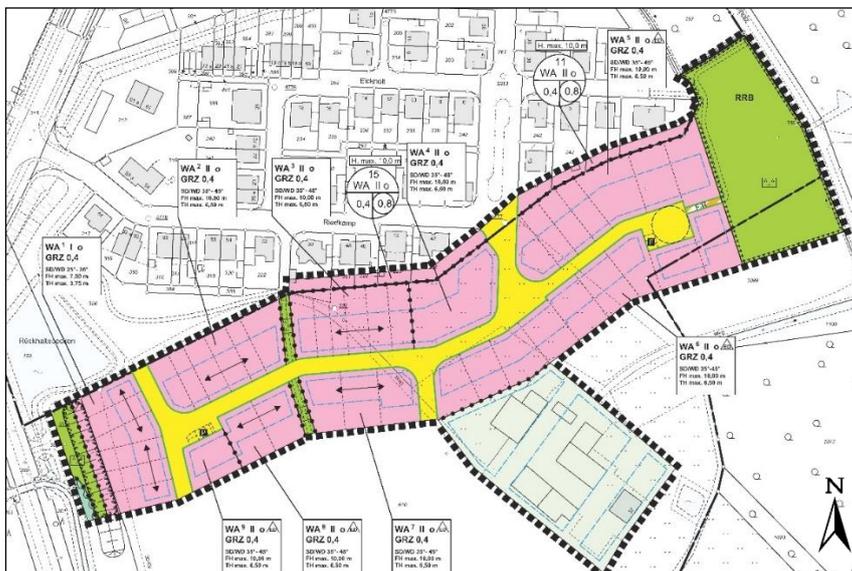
Planzeichnung zum Bebauungsplan (Ausschnitt, Entwurf)
